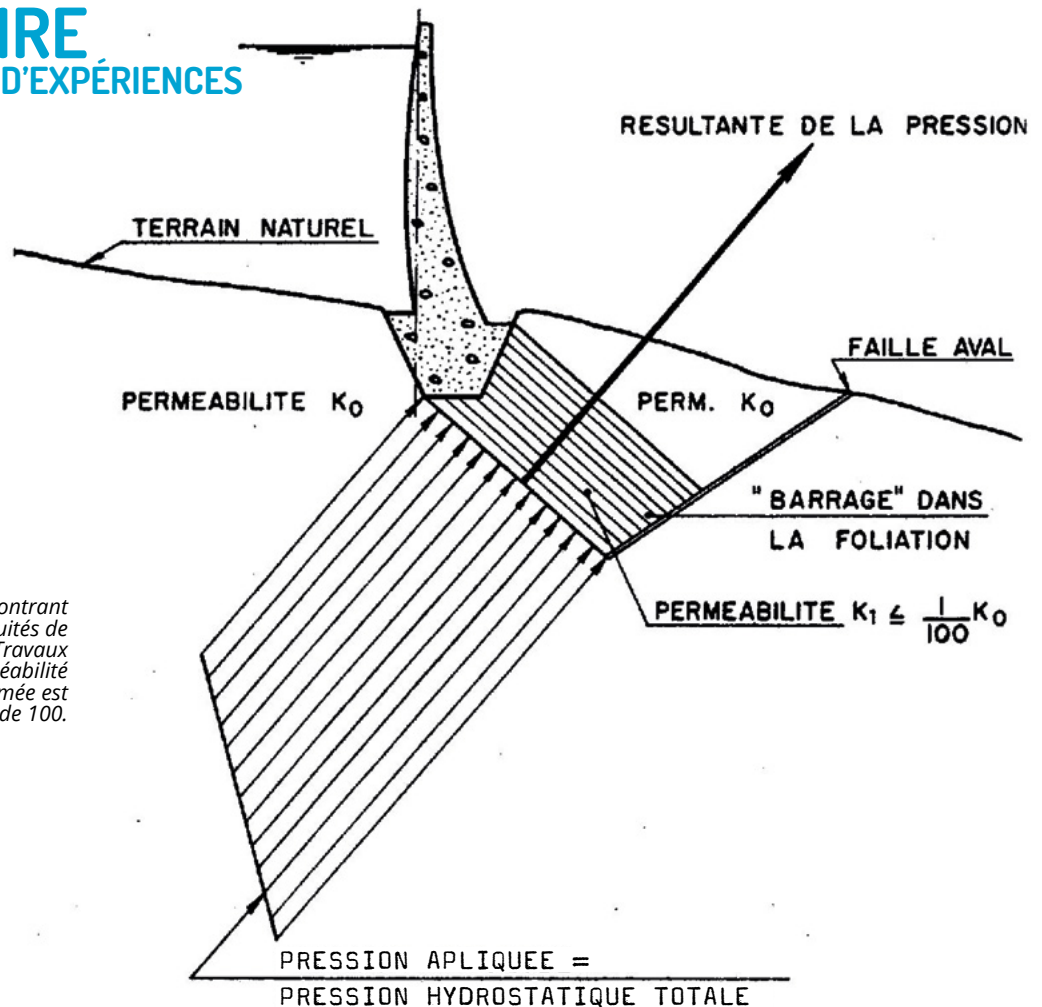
Coupe schématique montrant les deux familles de discontinuités de la fondation. Source revue Travaux de juillet 1967. La perméabilité dans la zone comprimée est divisée par plus de 100.
